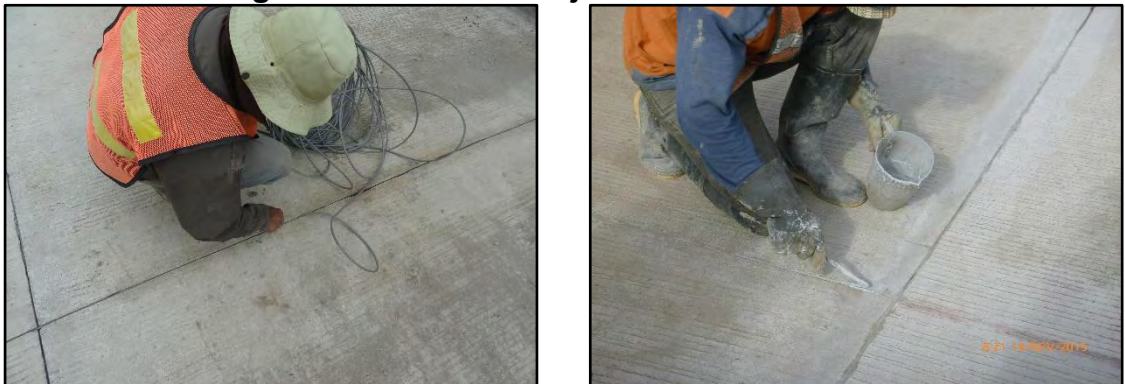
Curado del concreto y aserrado de juntas K0+000 – K0+200.
